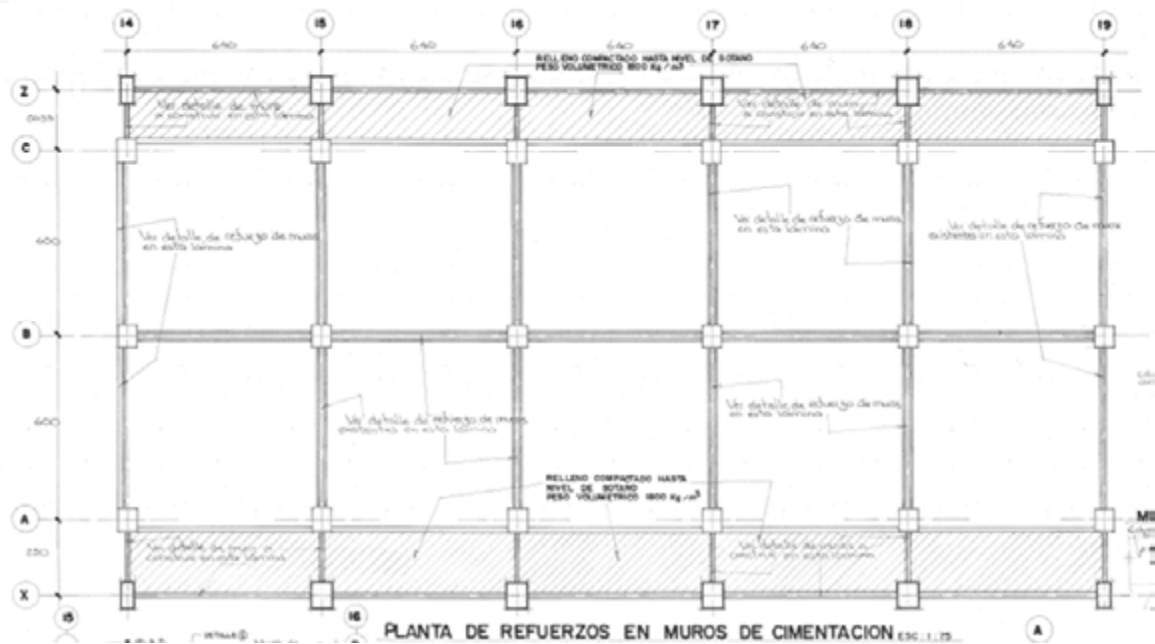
Planta estructural de refuerzos en muros de cimentación.
